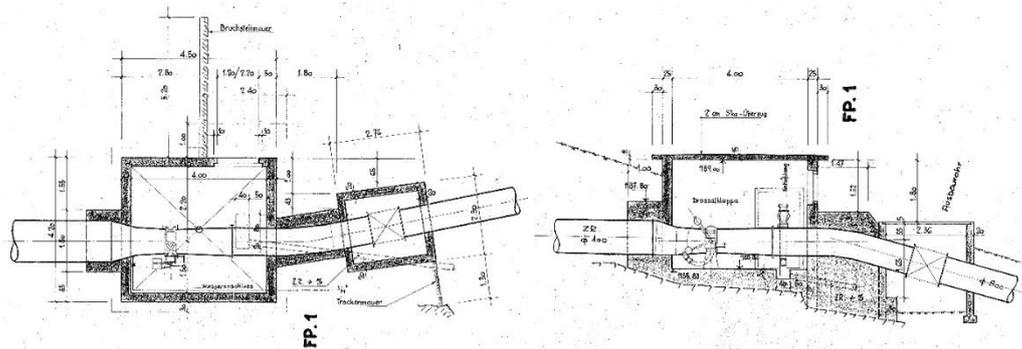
Grundriss (links) und Schnitt (rechts) der Apparatekammer (Ausschnitt Plan Nr. 500-133).
